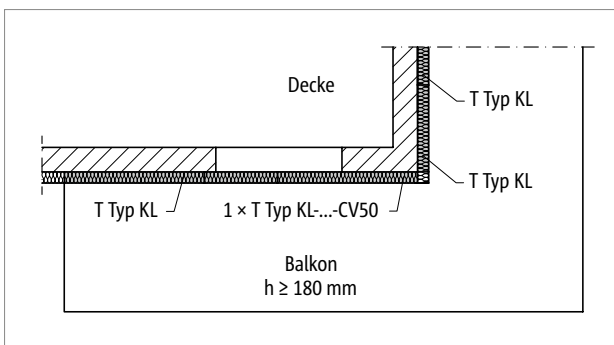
Schöck Isokorb® T Typ KL: Ausseneckbalkone
